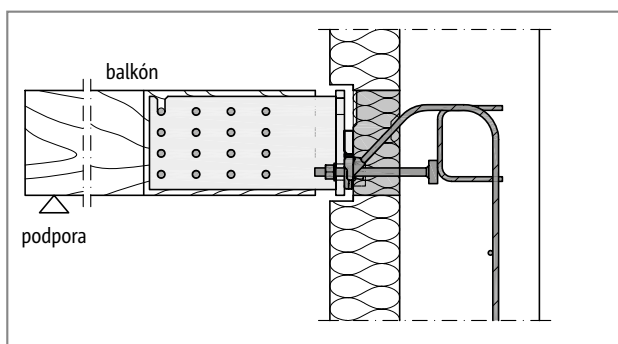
Schöck Isokorb® T typ SQP s přípojným adaptérem: Podepřený balkón
